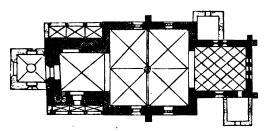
Prohn. Kirche. Grundriss. 1:667.
